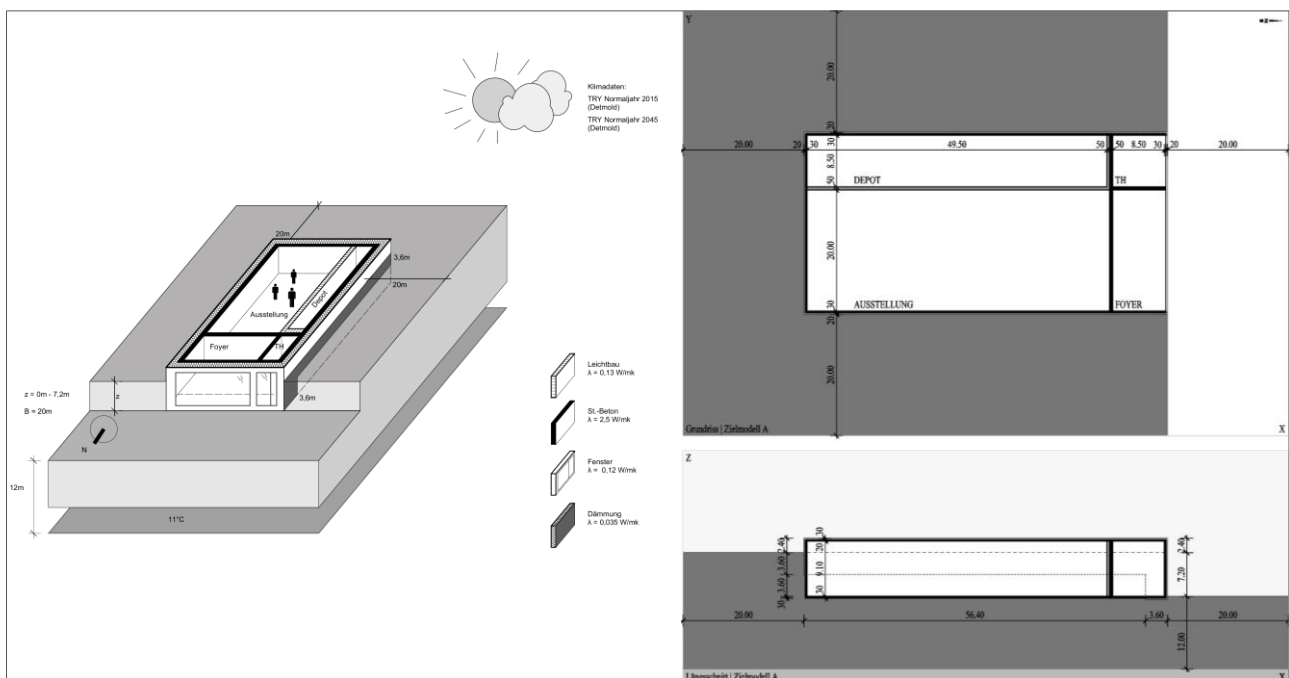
Zielmodell, Grundriss- und Schnittzeichnung - Depot, Treppenhaus, Foyer, Ausstellung
